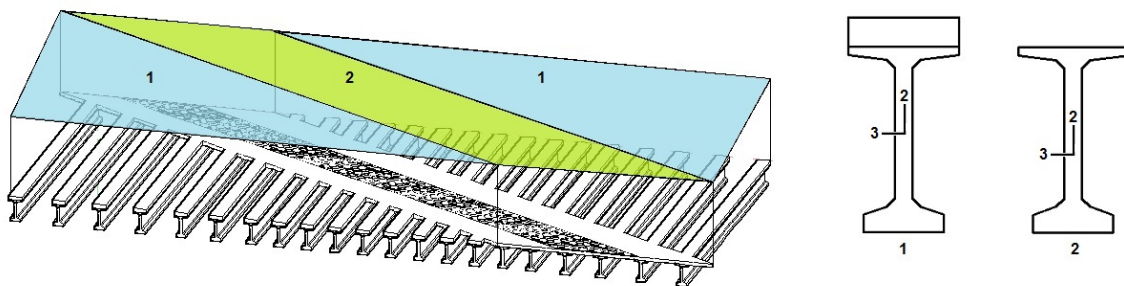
Tipología de sección de viga a emplear según su posición. (1)-Sección compuesta hormigón HA-30-viga HP-50. (2)-Sección viga HP-50
